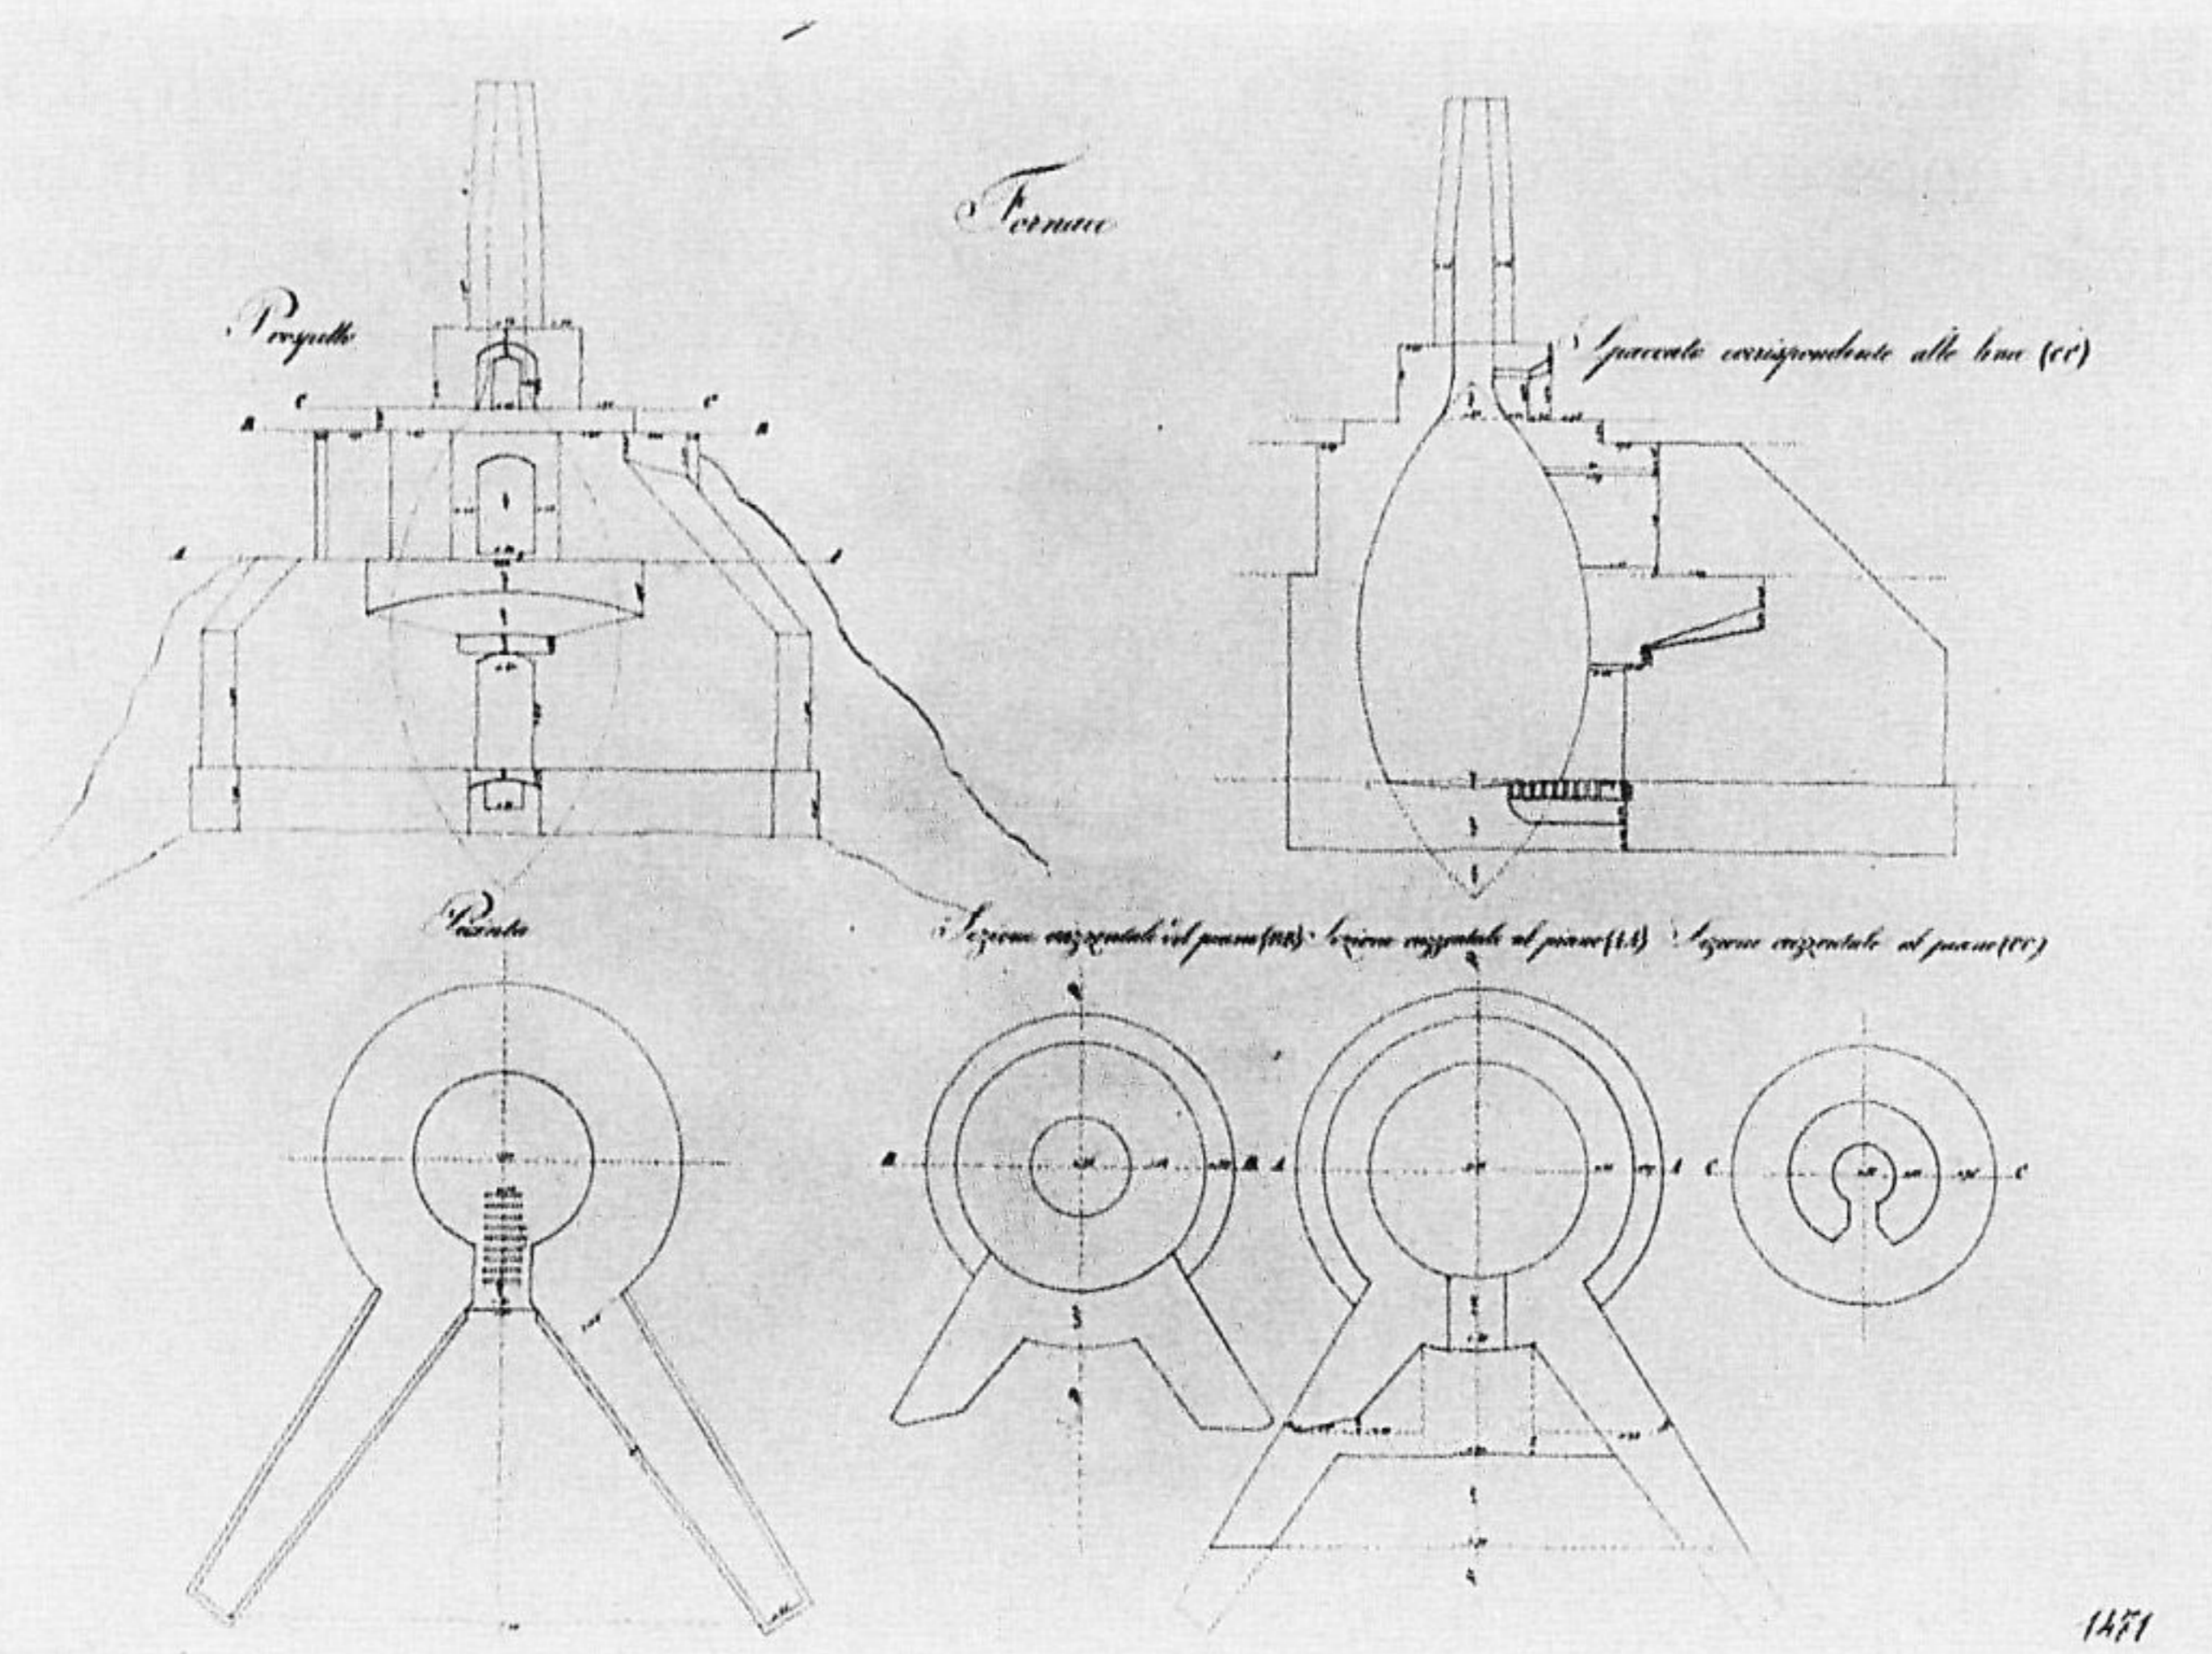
Fornace, prospetto e sezioni (S.D.). Padova, Museo Civico.
